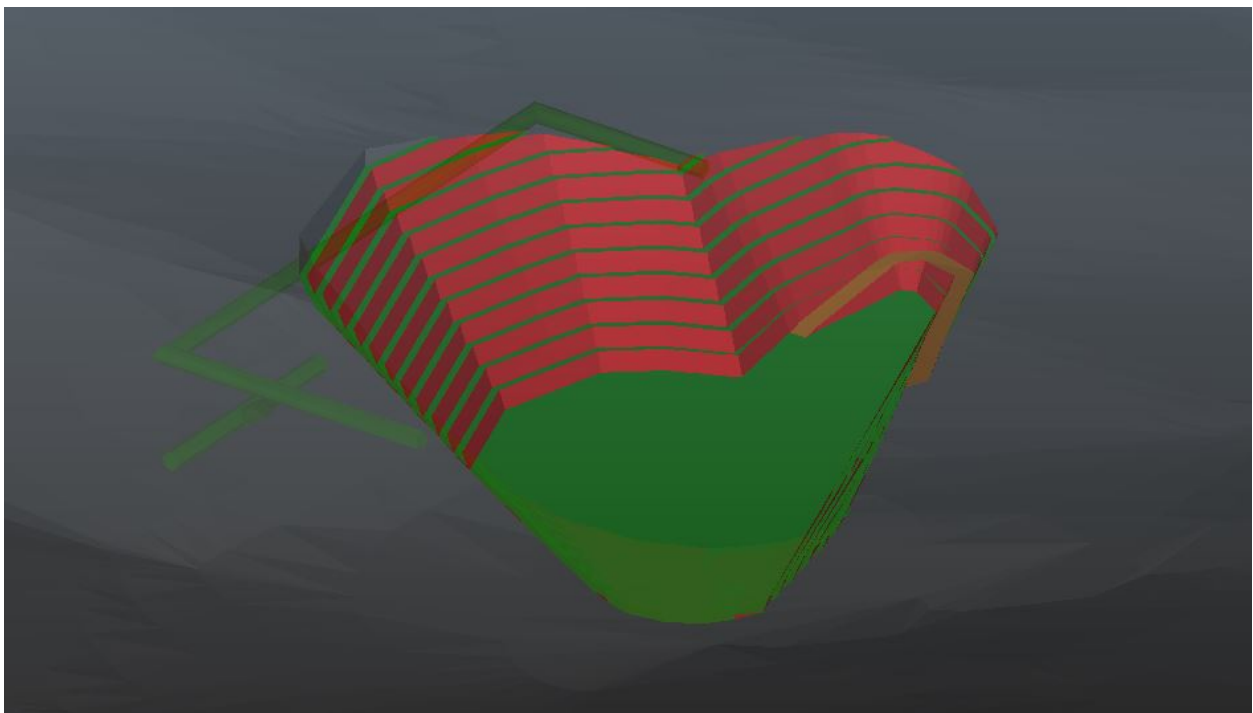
Vista espaciamento entre galería y Pit 2.
